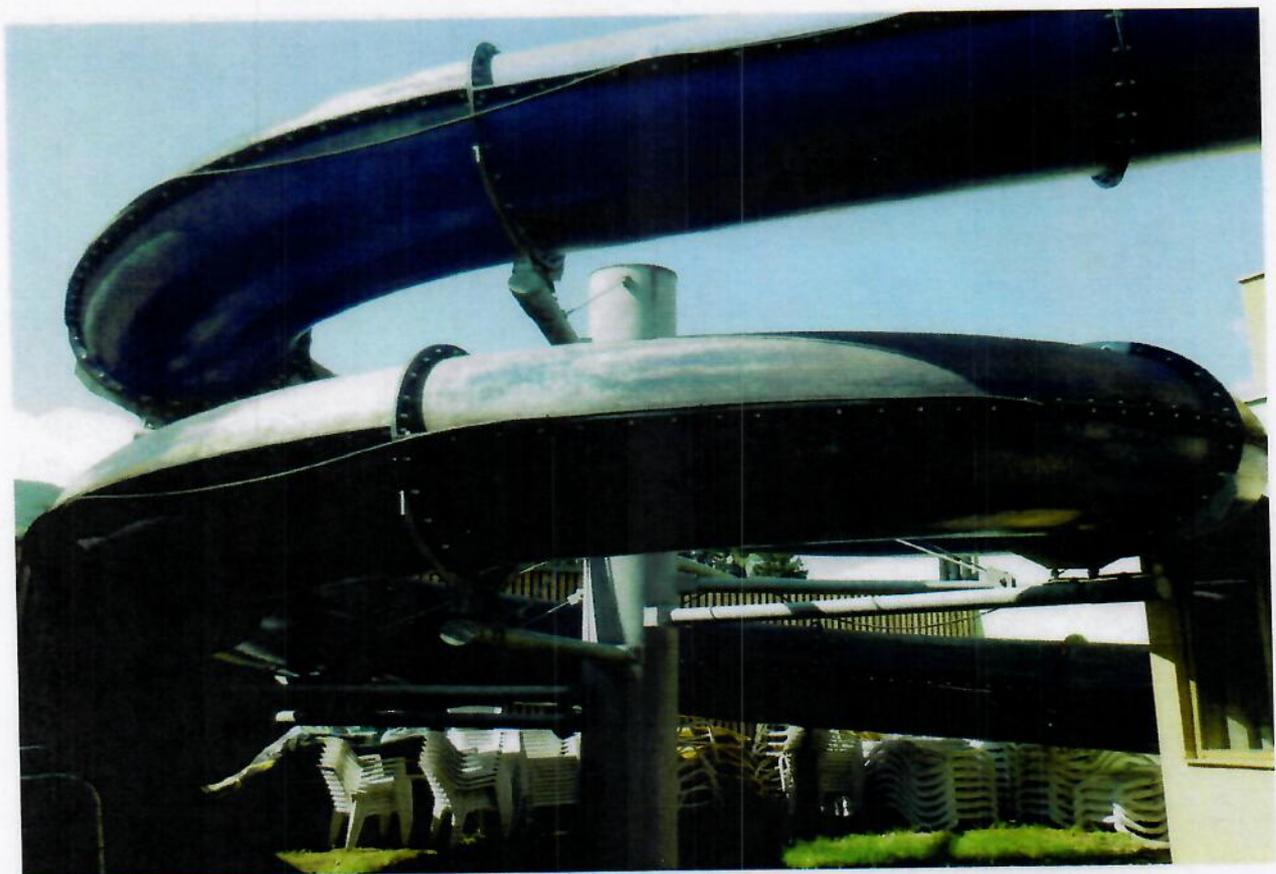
\_Aussenanlagen 09: Außenbereich Tunnelrutsche
